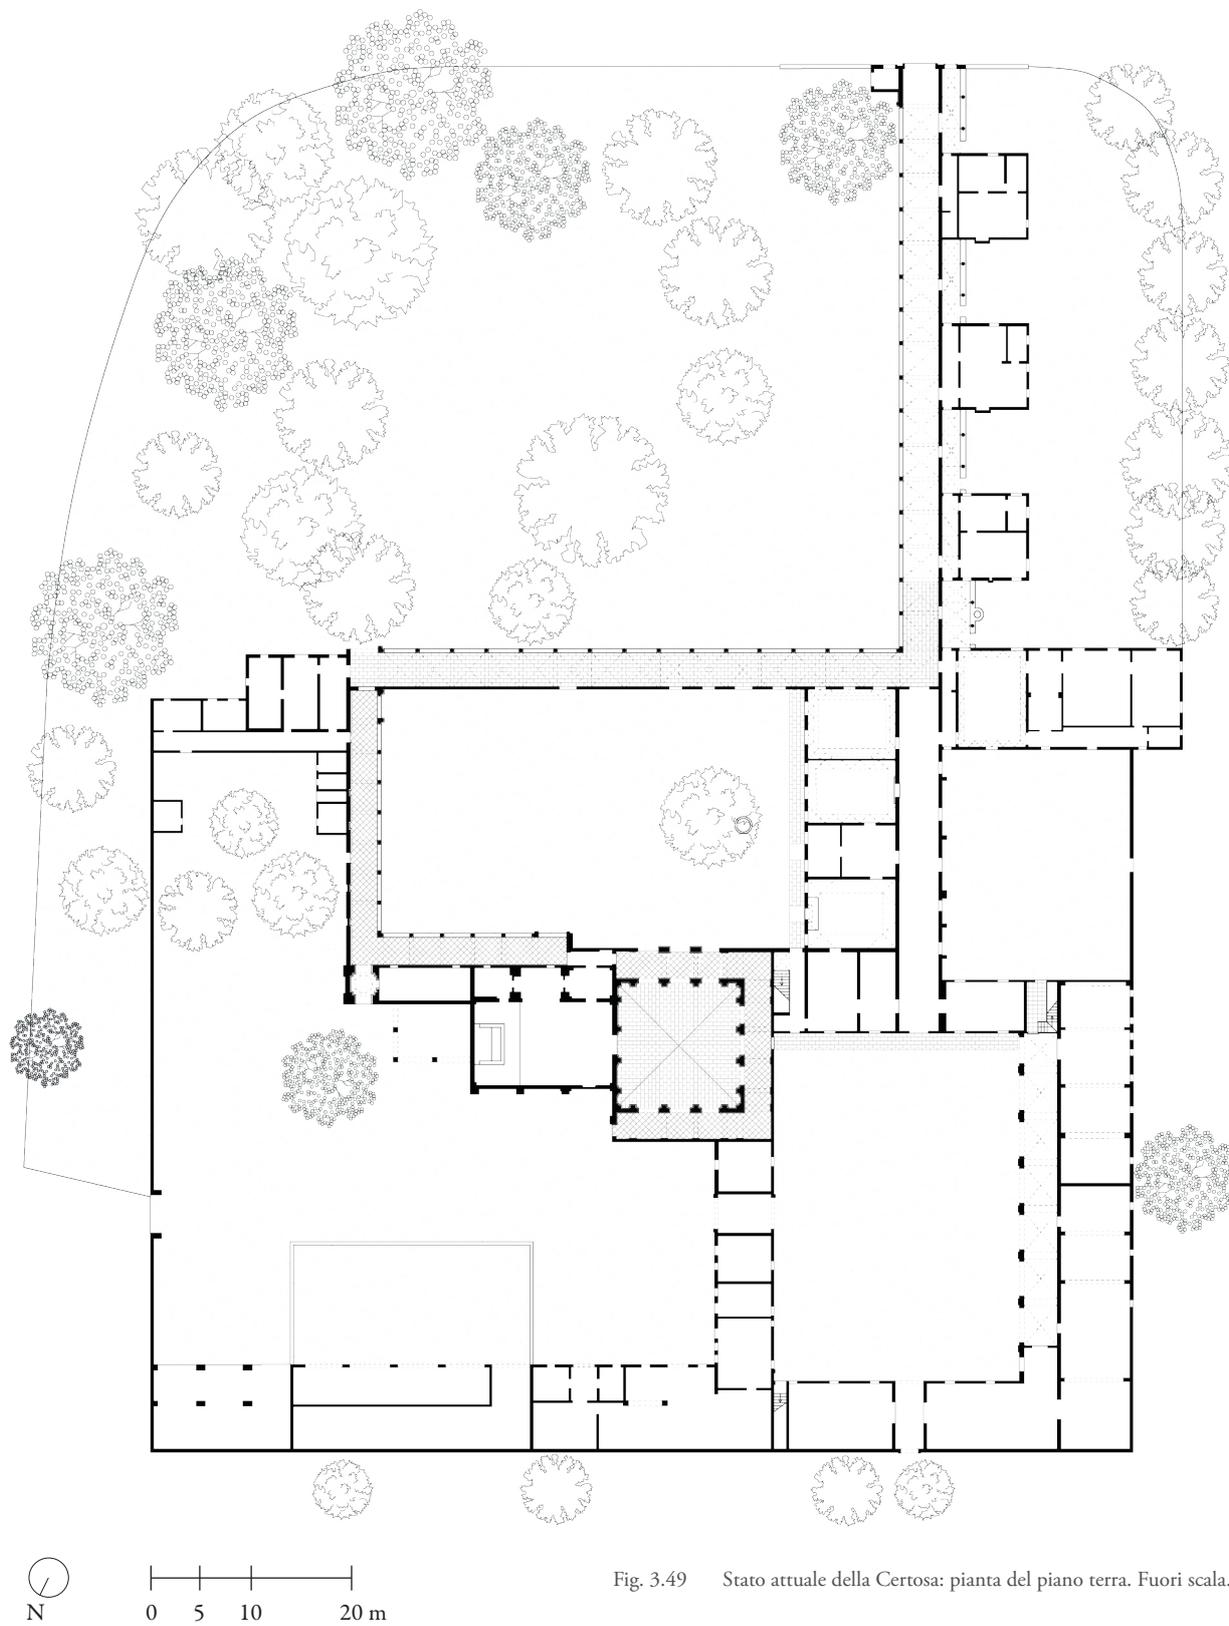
Stato attuale della Certosa: pianta del piano terra. Fuori scala.
